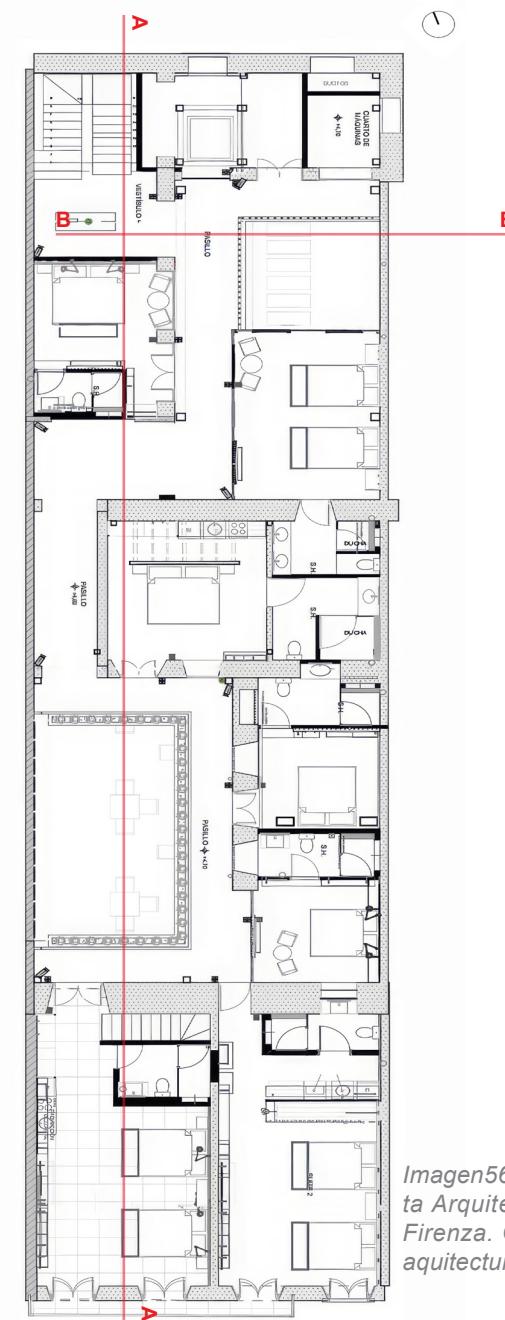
Ilustración Planta Arquitectónica de Casa Firenza. Obtenida de INAI arquitectura.
